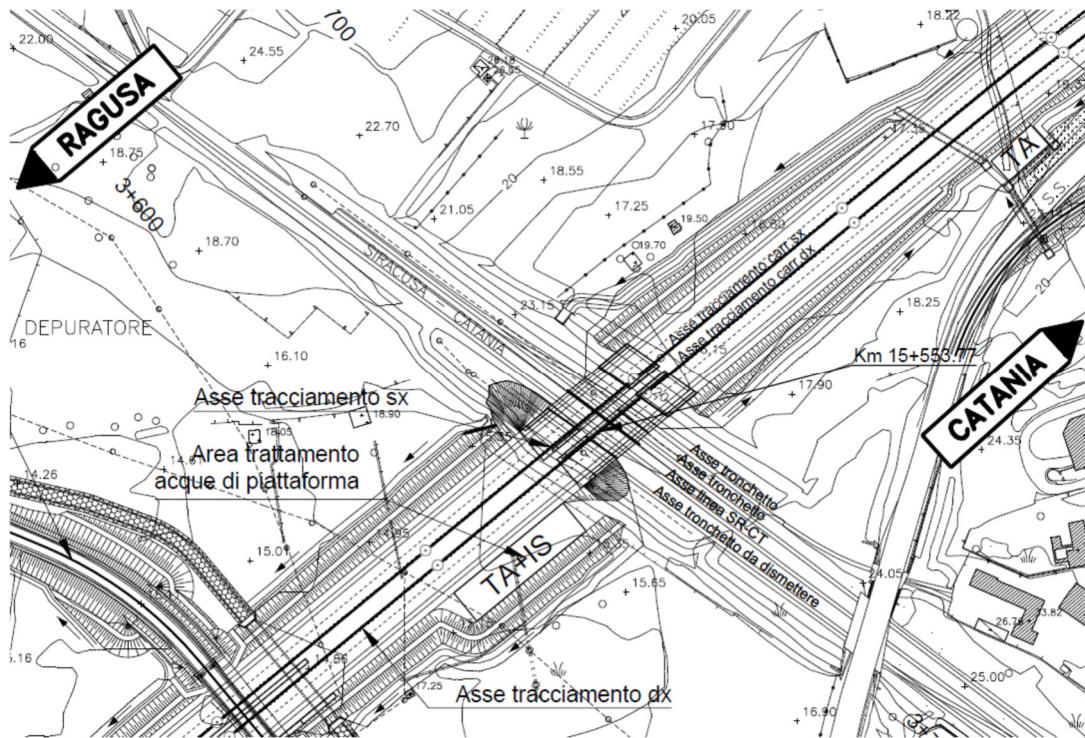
Stralcio planimetrico con individuazione dell'opera.
